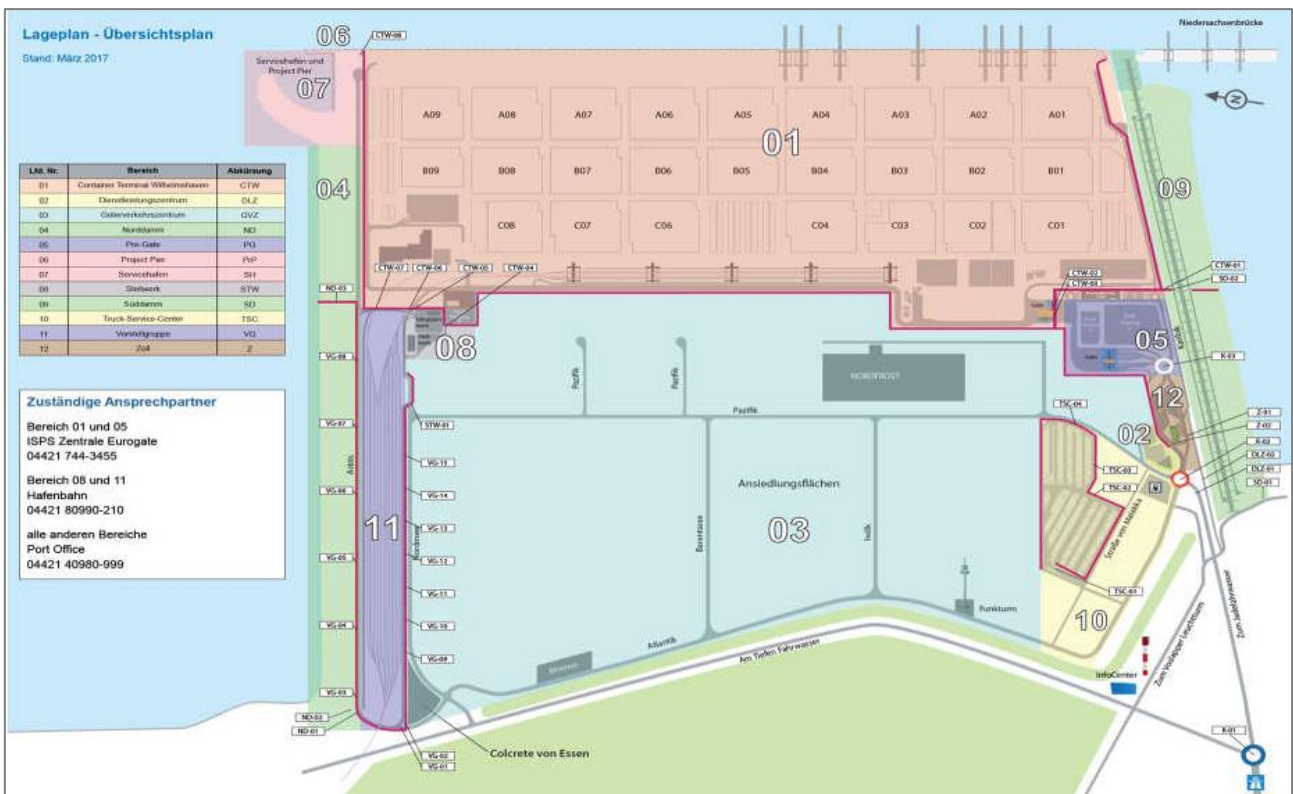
Containerterminal JadeWeserPort mit geplanter Vormontagefläche (Fläche 06)
